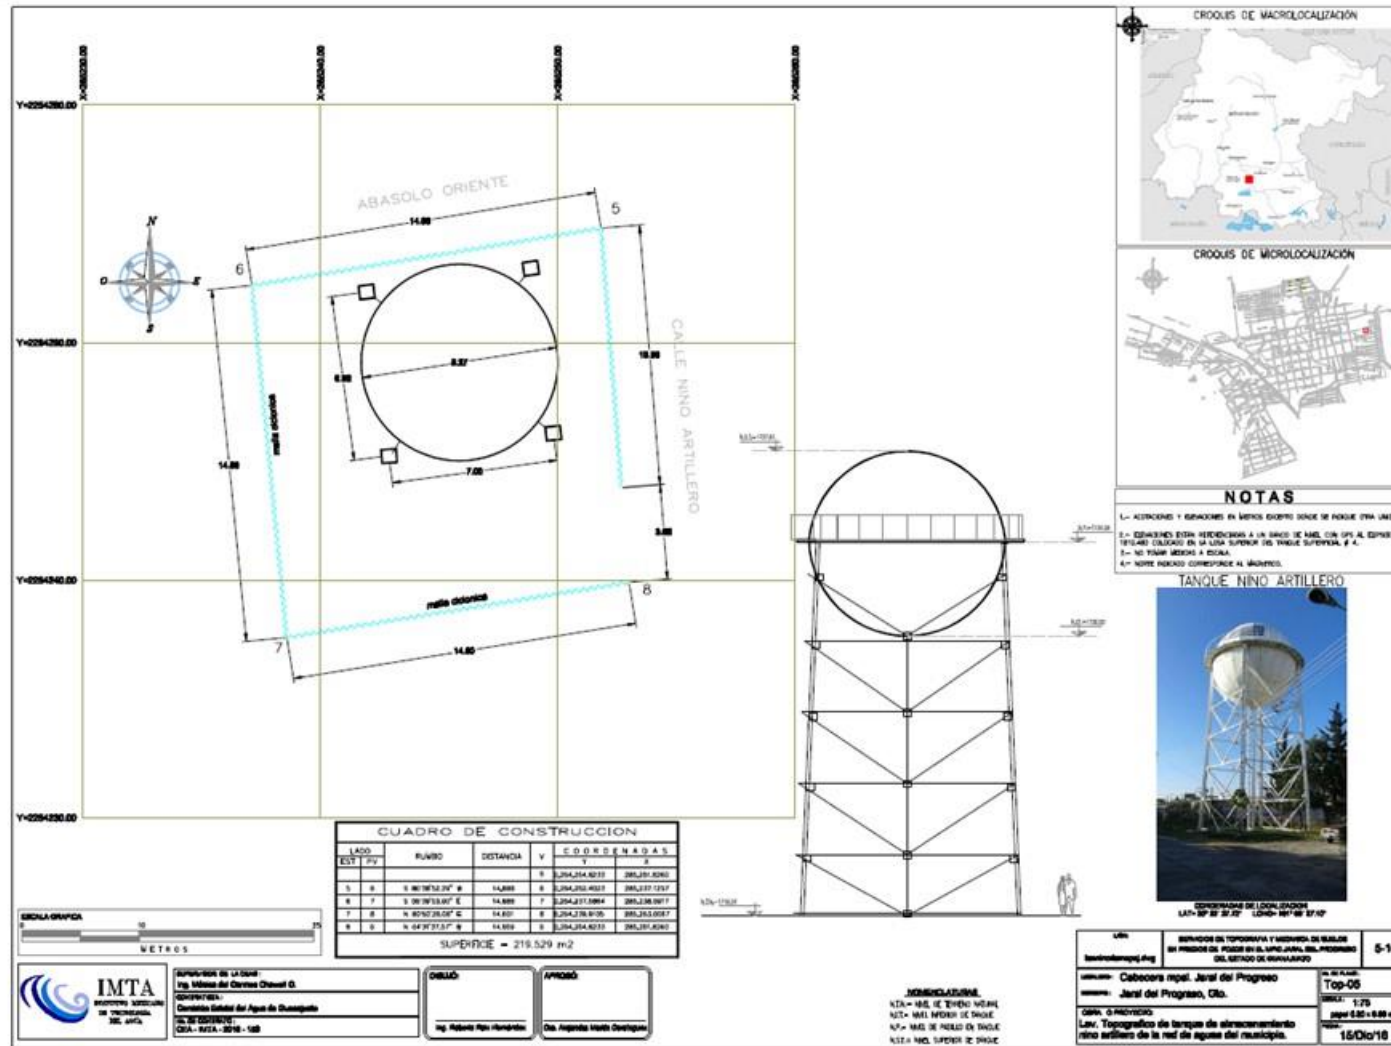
Levantamiento Tanque Niño Artillero (Ver anexo de planos para más detalle)
